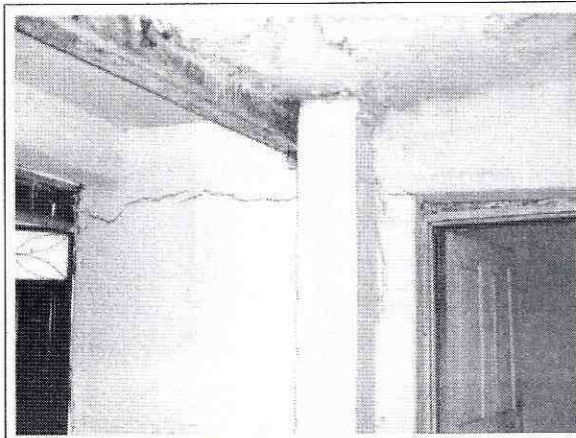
Fisuras y grietas en los muros del segundo piso
